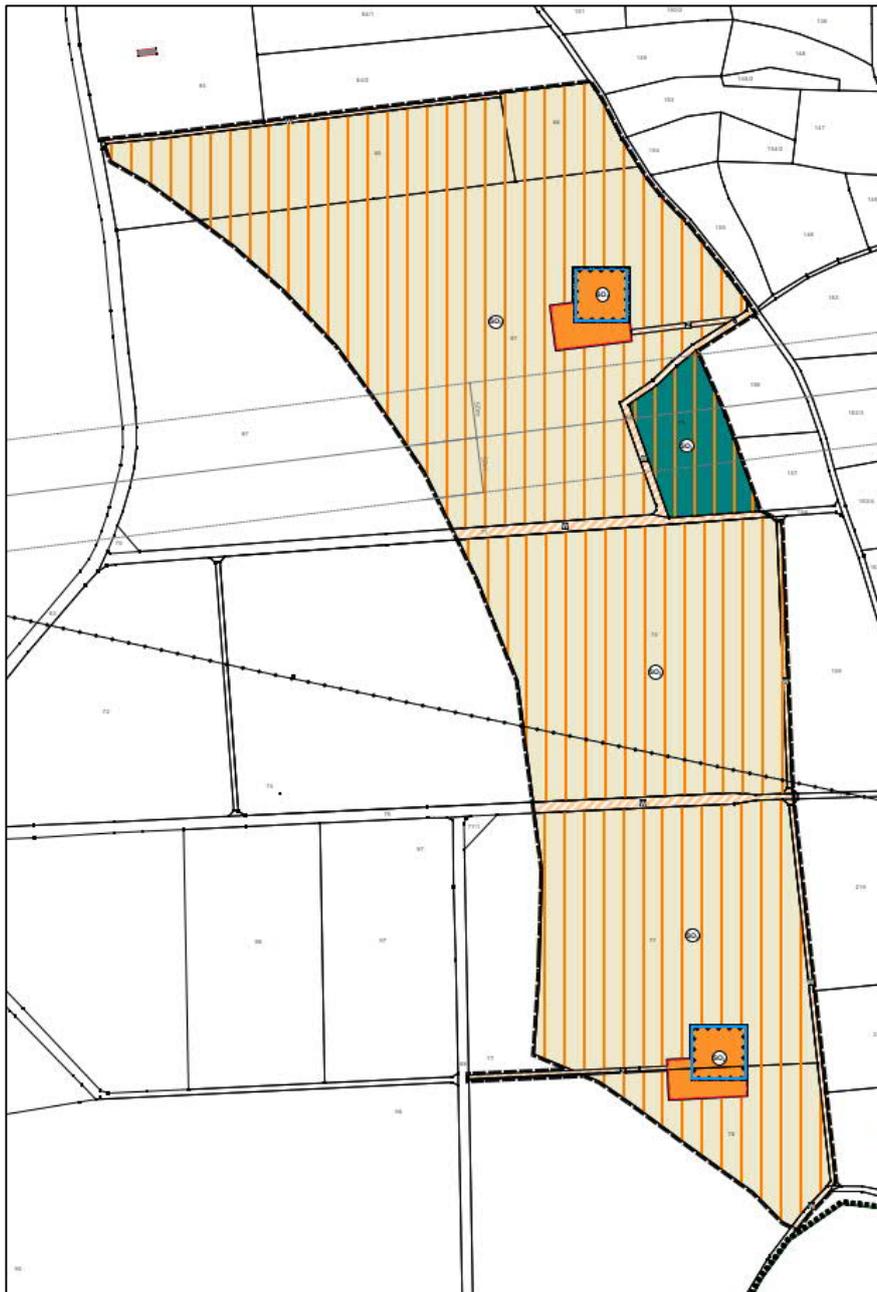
Auszug aus dem Bebauungsplan /2.1.1/;
